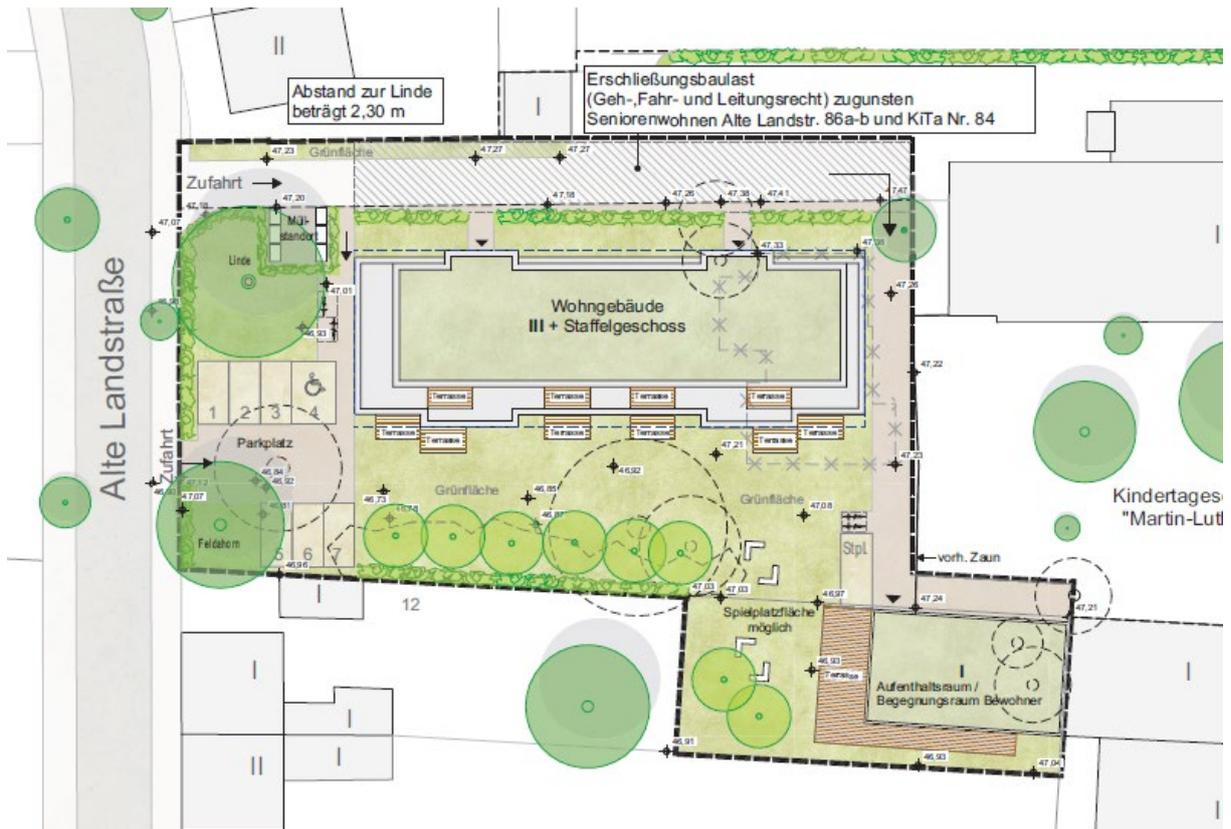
Städtebaulicher Entwurf, Variante A, Lageplan – ohne Maßstab
